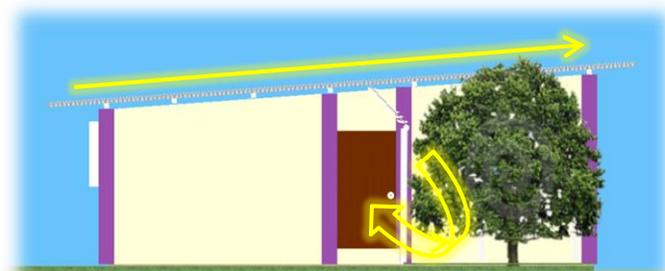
Techo Inclinado a favor de los viento. Fachada posterior. Fuente: Propia.
